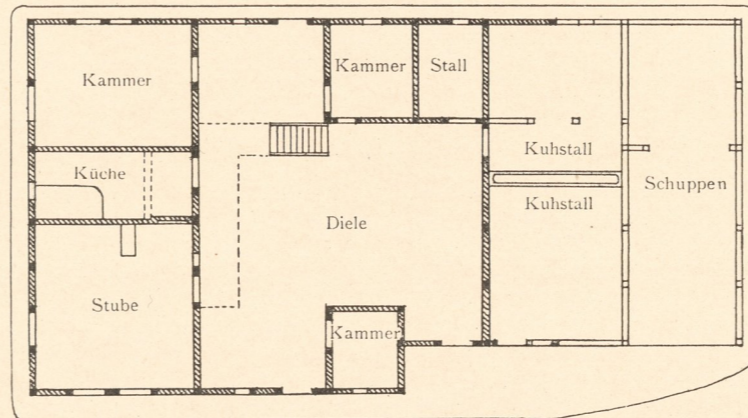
Gross-Lafferde. Grundriss.
